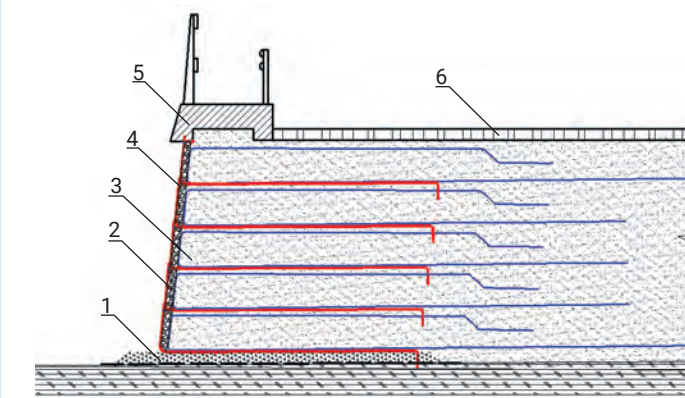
Конструкция вертикального откоса насыпи с применением арматурных блоков: 1 — укрепленное основание из геотексту со щебнем; 2 — удерживающий блок; 3 — геобойма; 4 — облицовка стены из камня (вариант); 5 — шапочный брус; 6 — дорожное покрытие
